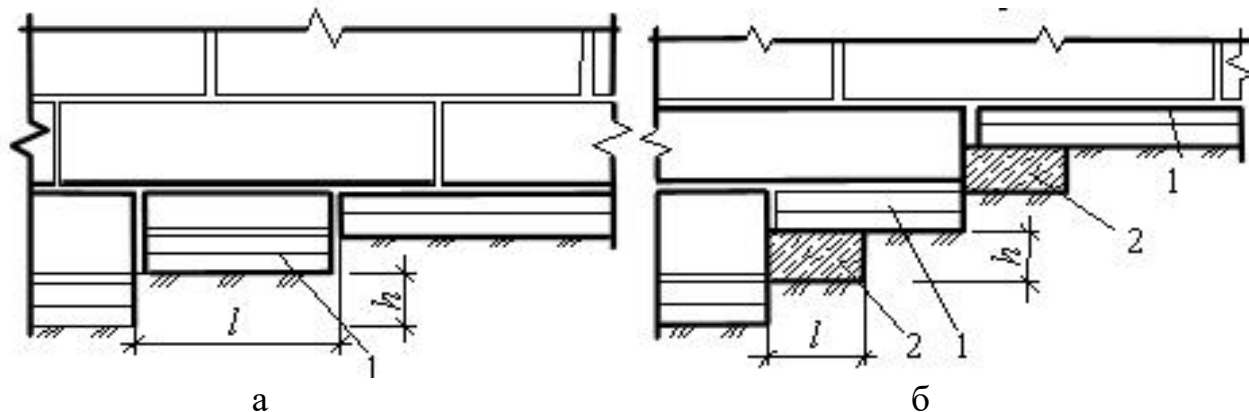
Перехід фундаменту від однієї глибини закладання до іншої:
